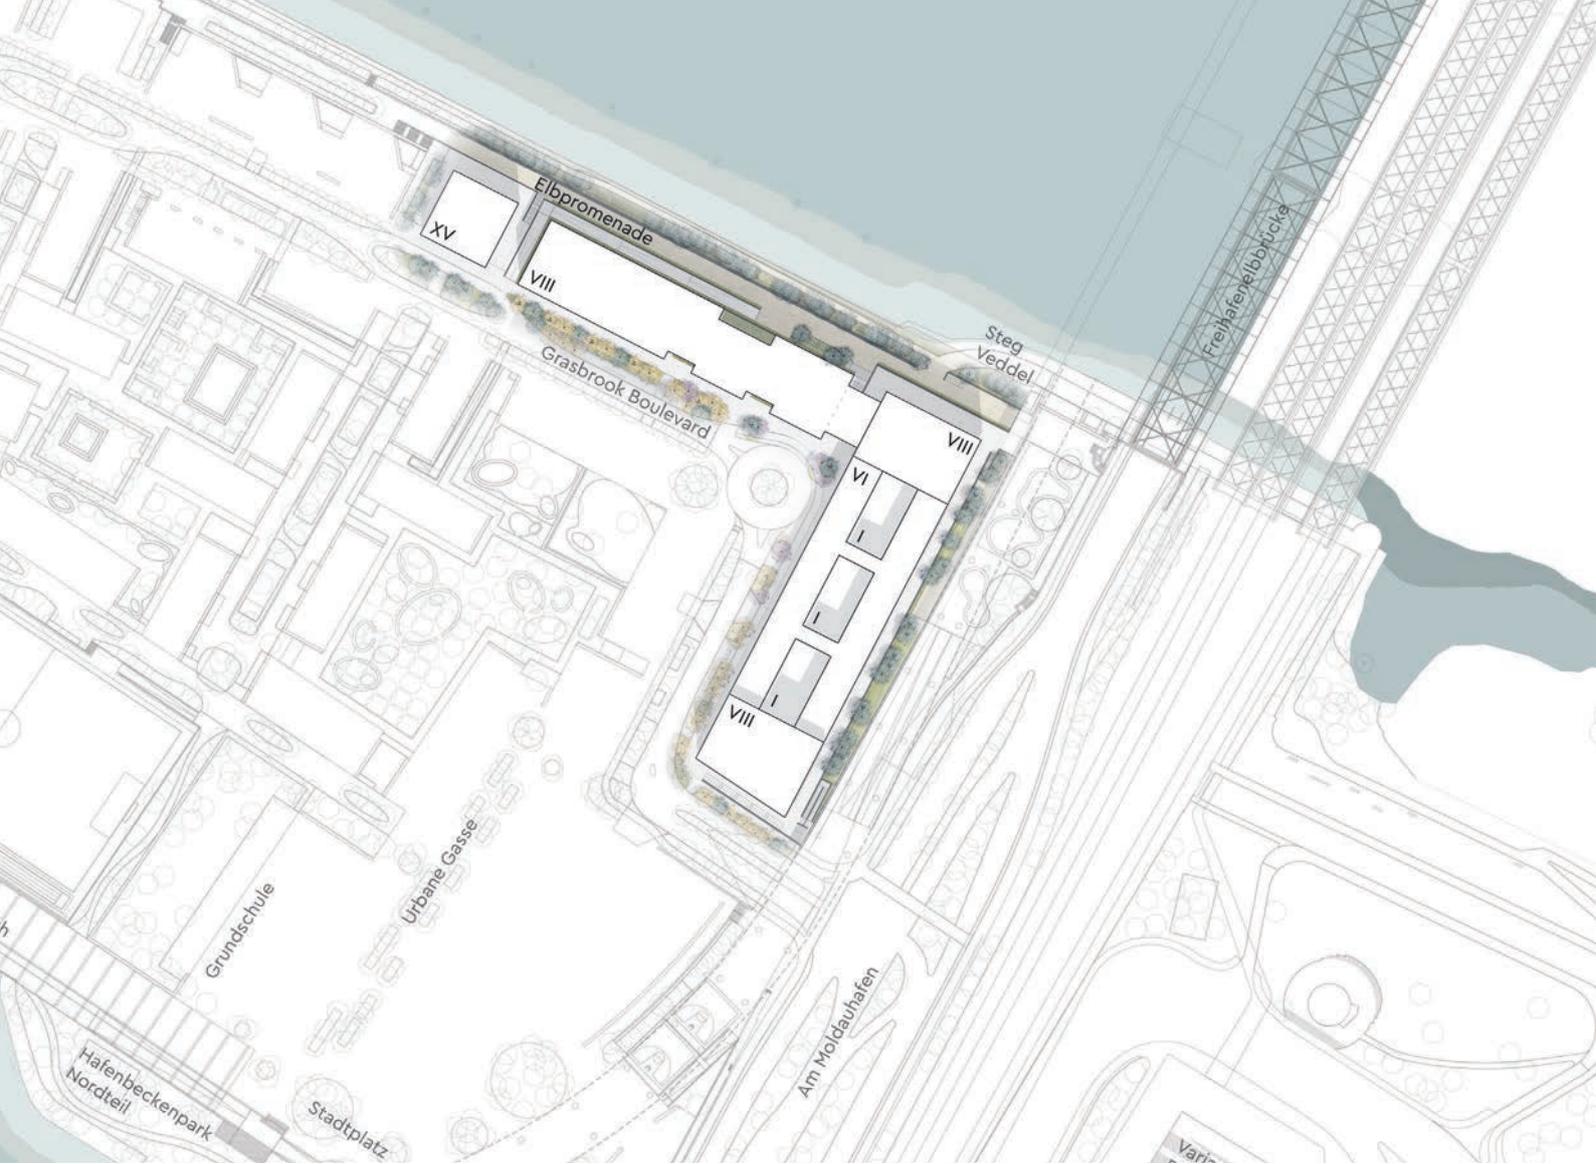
Lageplan Baufelder 9, 10, 17
